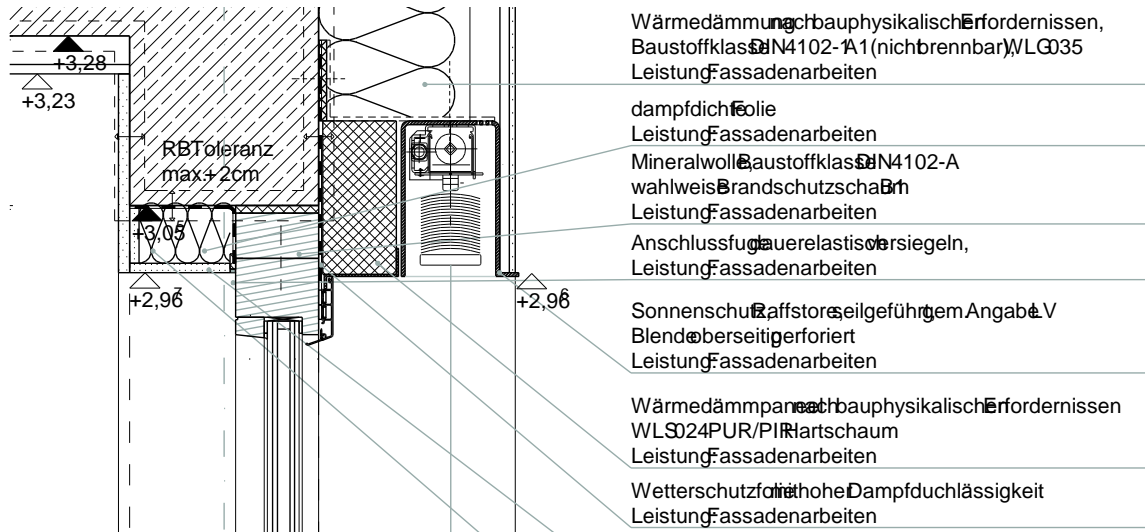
Schnitt Holz-Glas-Fassade mit Raffstores [21]
